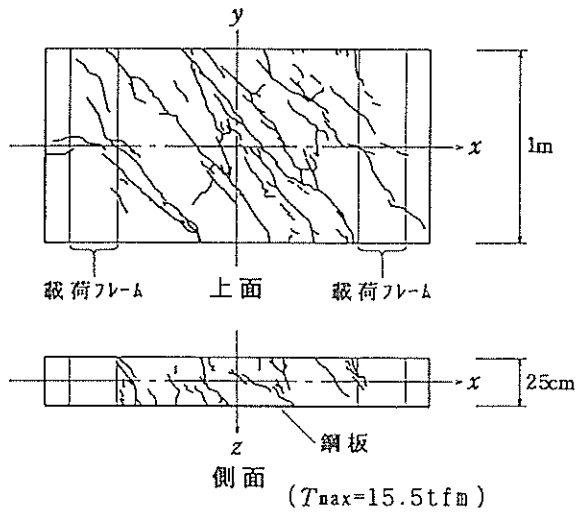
供試体 OS-19-200のひび割れ発生位置
